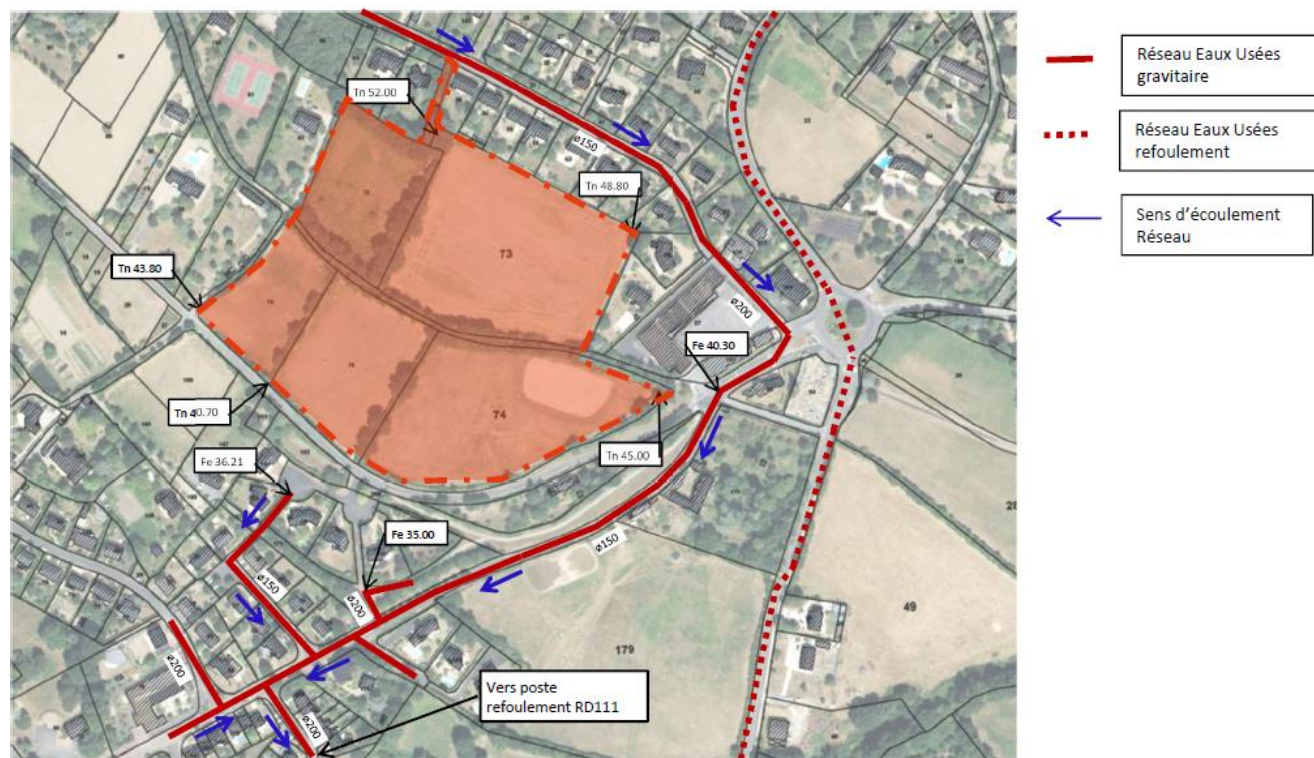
Extrait du plan du réseau d'assainissement des eaux usées
